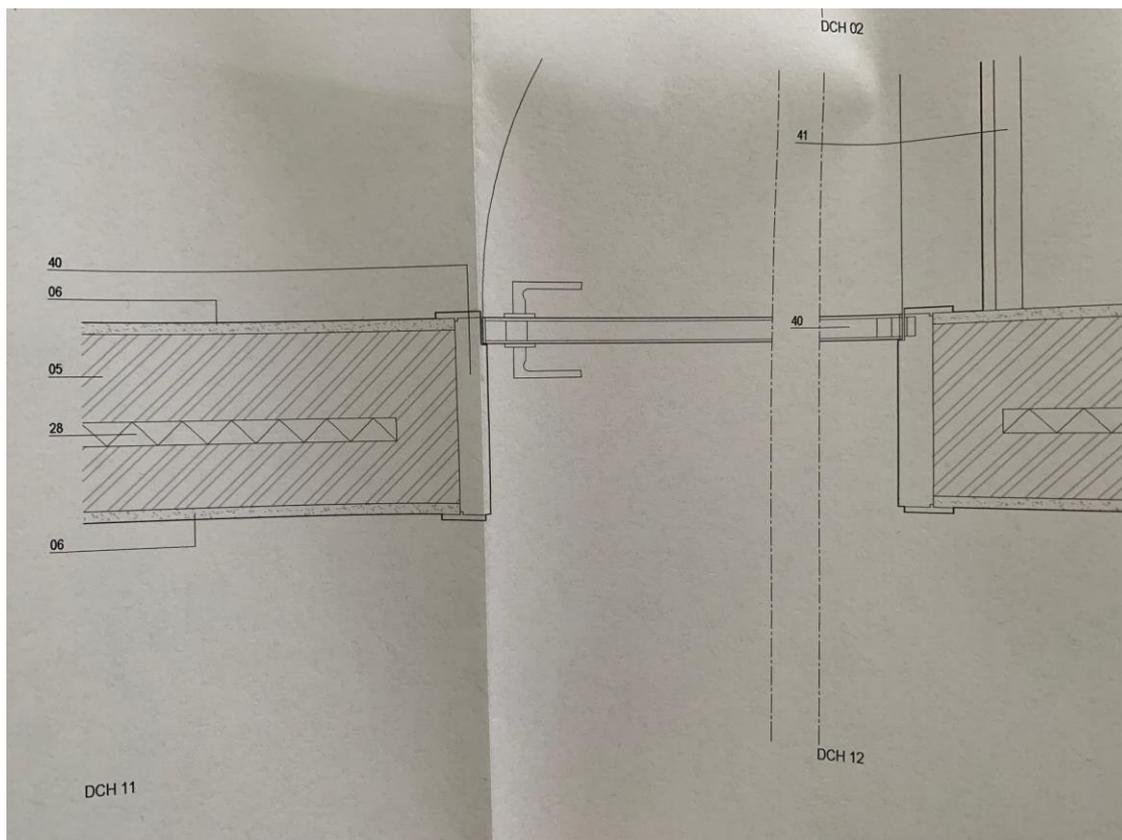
PLANTA PORMENOR CONSTRUTIVO DE REMATE OMBREIRA
